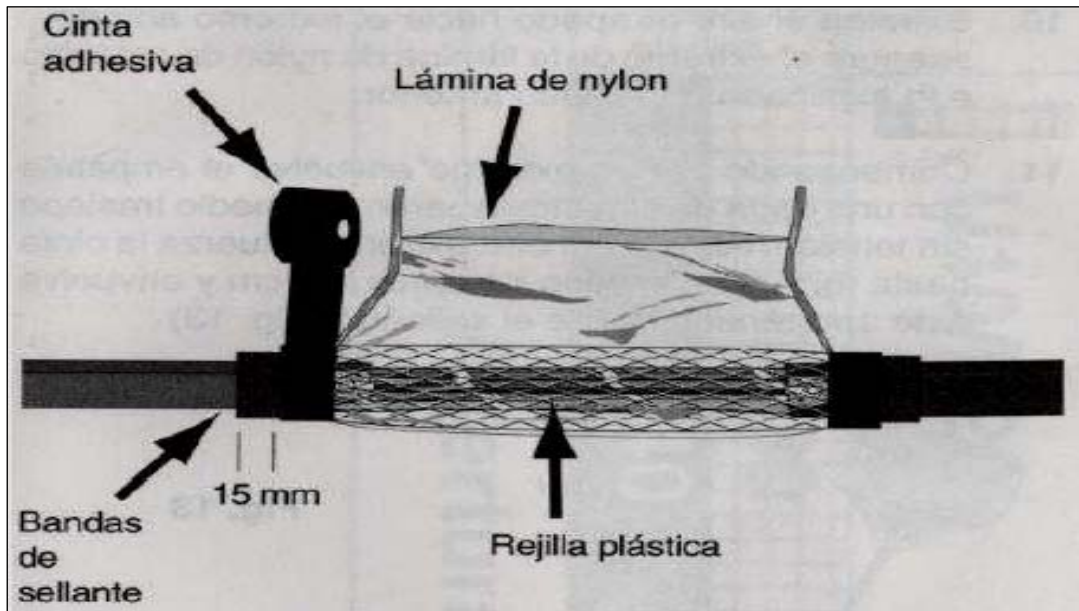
Colocación de la Rejilla y Cubierta Nylon
